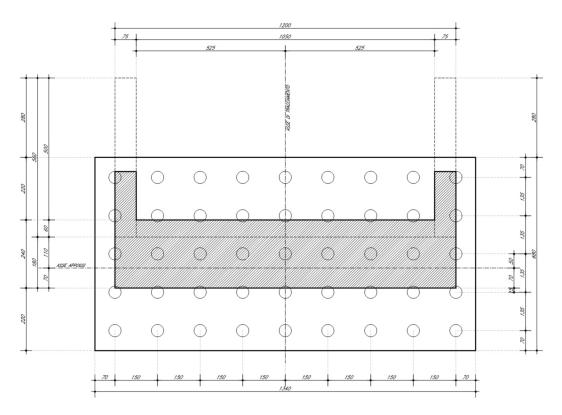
Pianta fondazione e spiccato elevazione spalla B
